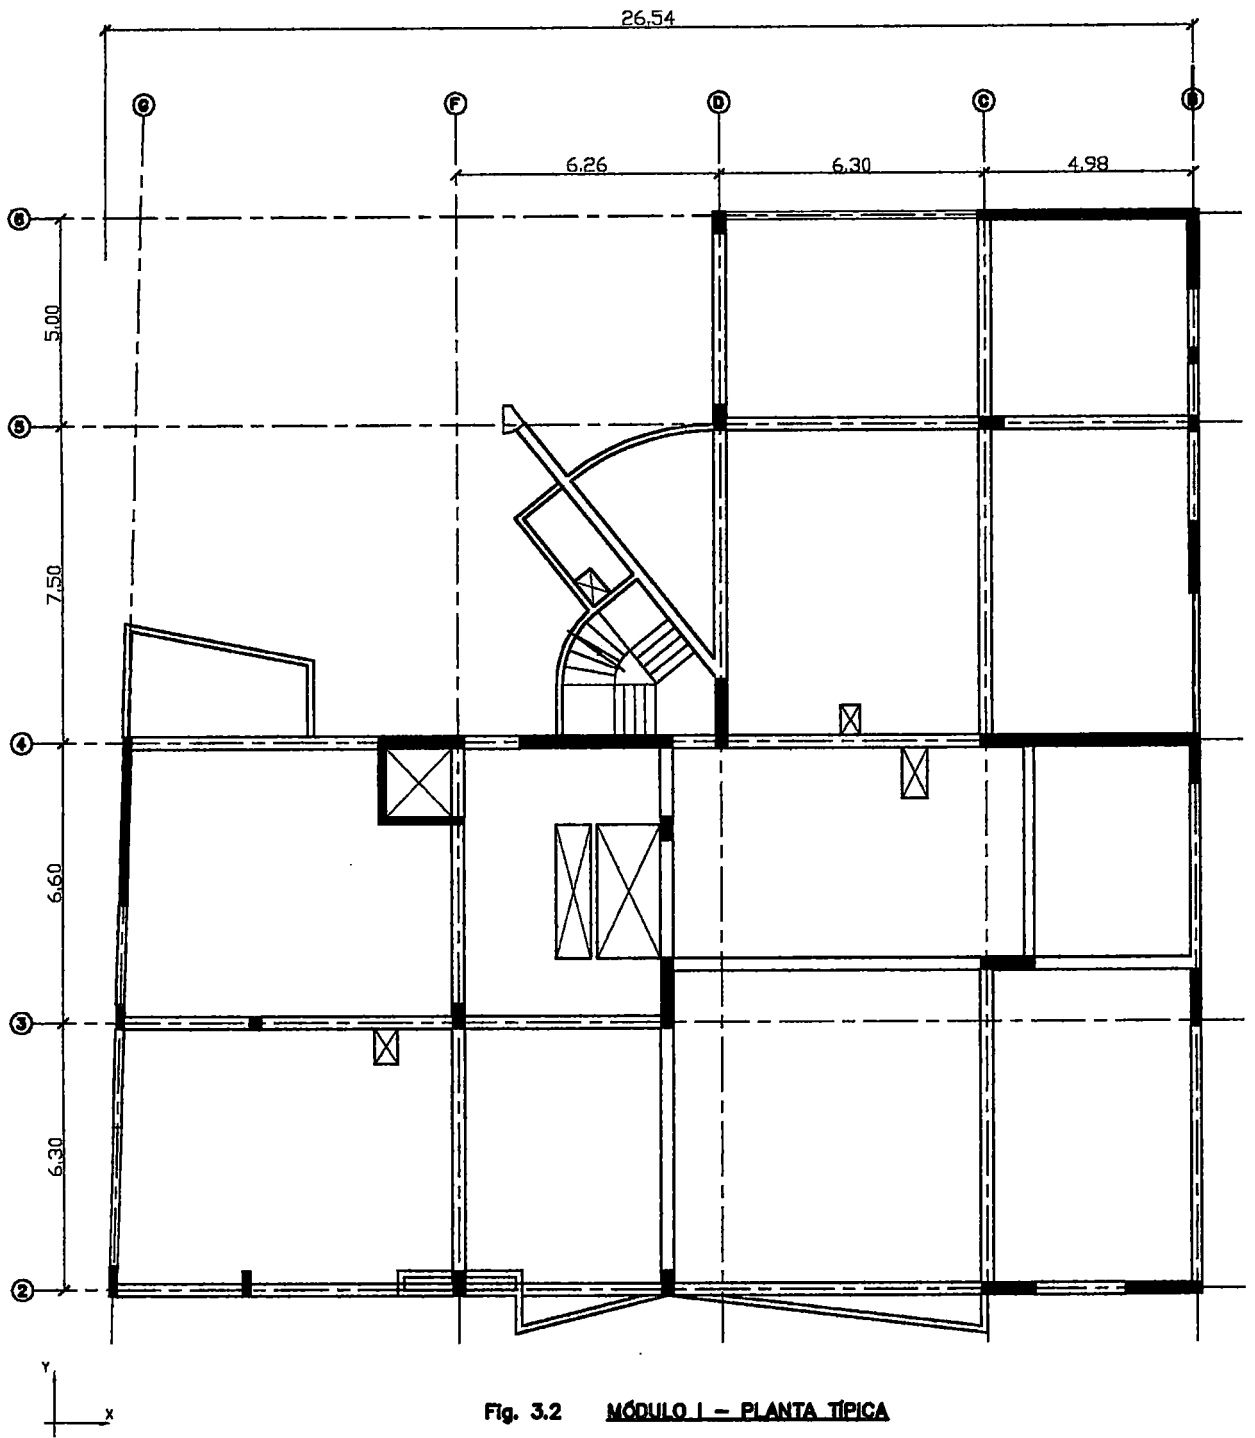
MÓDULO I - PLANTA TÍPICA
